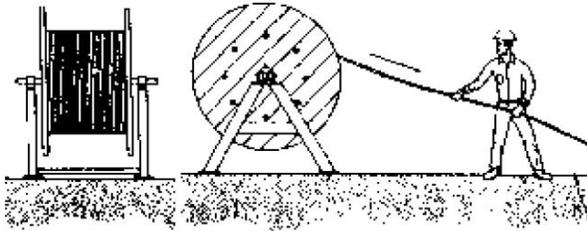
a) Utilización de Gato Para Bobina en el manejo del Carrete de Cables.
